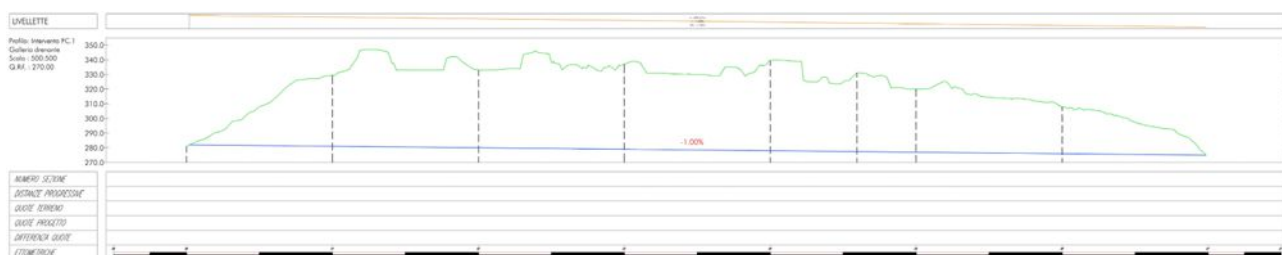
Profilo altimetrico d'asse dell'orizzontamento inferiore della galleria drenante.
